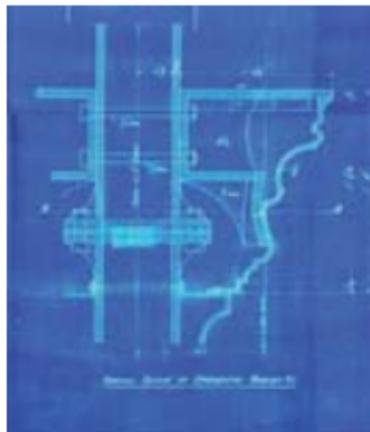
, 208 y 209. El antiguo pabellón mexicano para la Exposición de Nueva Orleans de 1884, hoy quiosco de Santa María la Ribera. Plano original del detalle constructivo de las columnas de hierro fundido, de la fundición *Keystone Bridge Company* (plano completo y detalle), en: AHDF, planoteca, caja 123, exp. 23. Foto: RV, 2012 (abajo derecha) El perfil de la columna del quiosco, que se realizó tal cual el plano del proyecto
